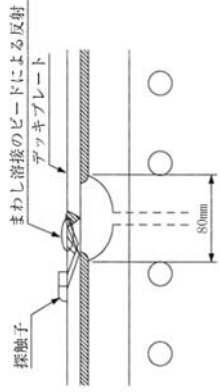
デッキプレート溶接部の超音波探傷による検査の例
